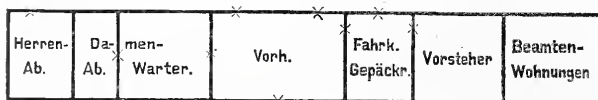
Grundriss eines kleinen englischen Empfangsgebäudes.
